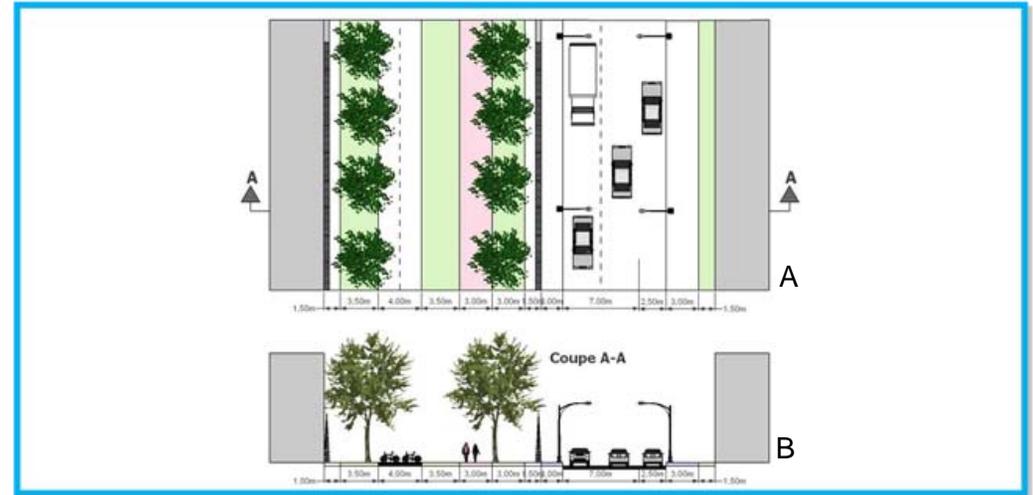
(A) Plan et (B) coupe de la rue Keefe
